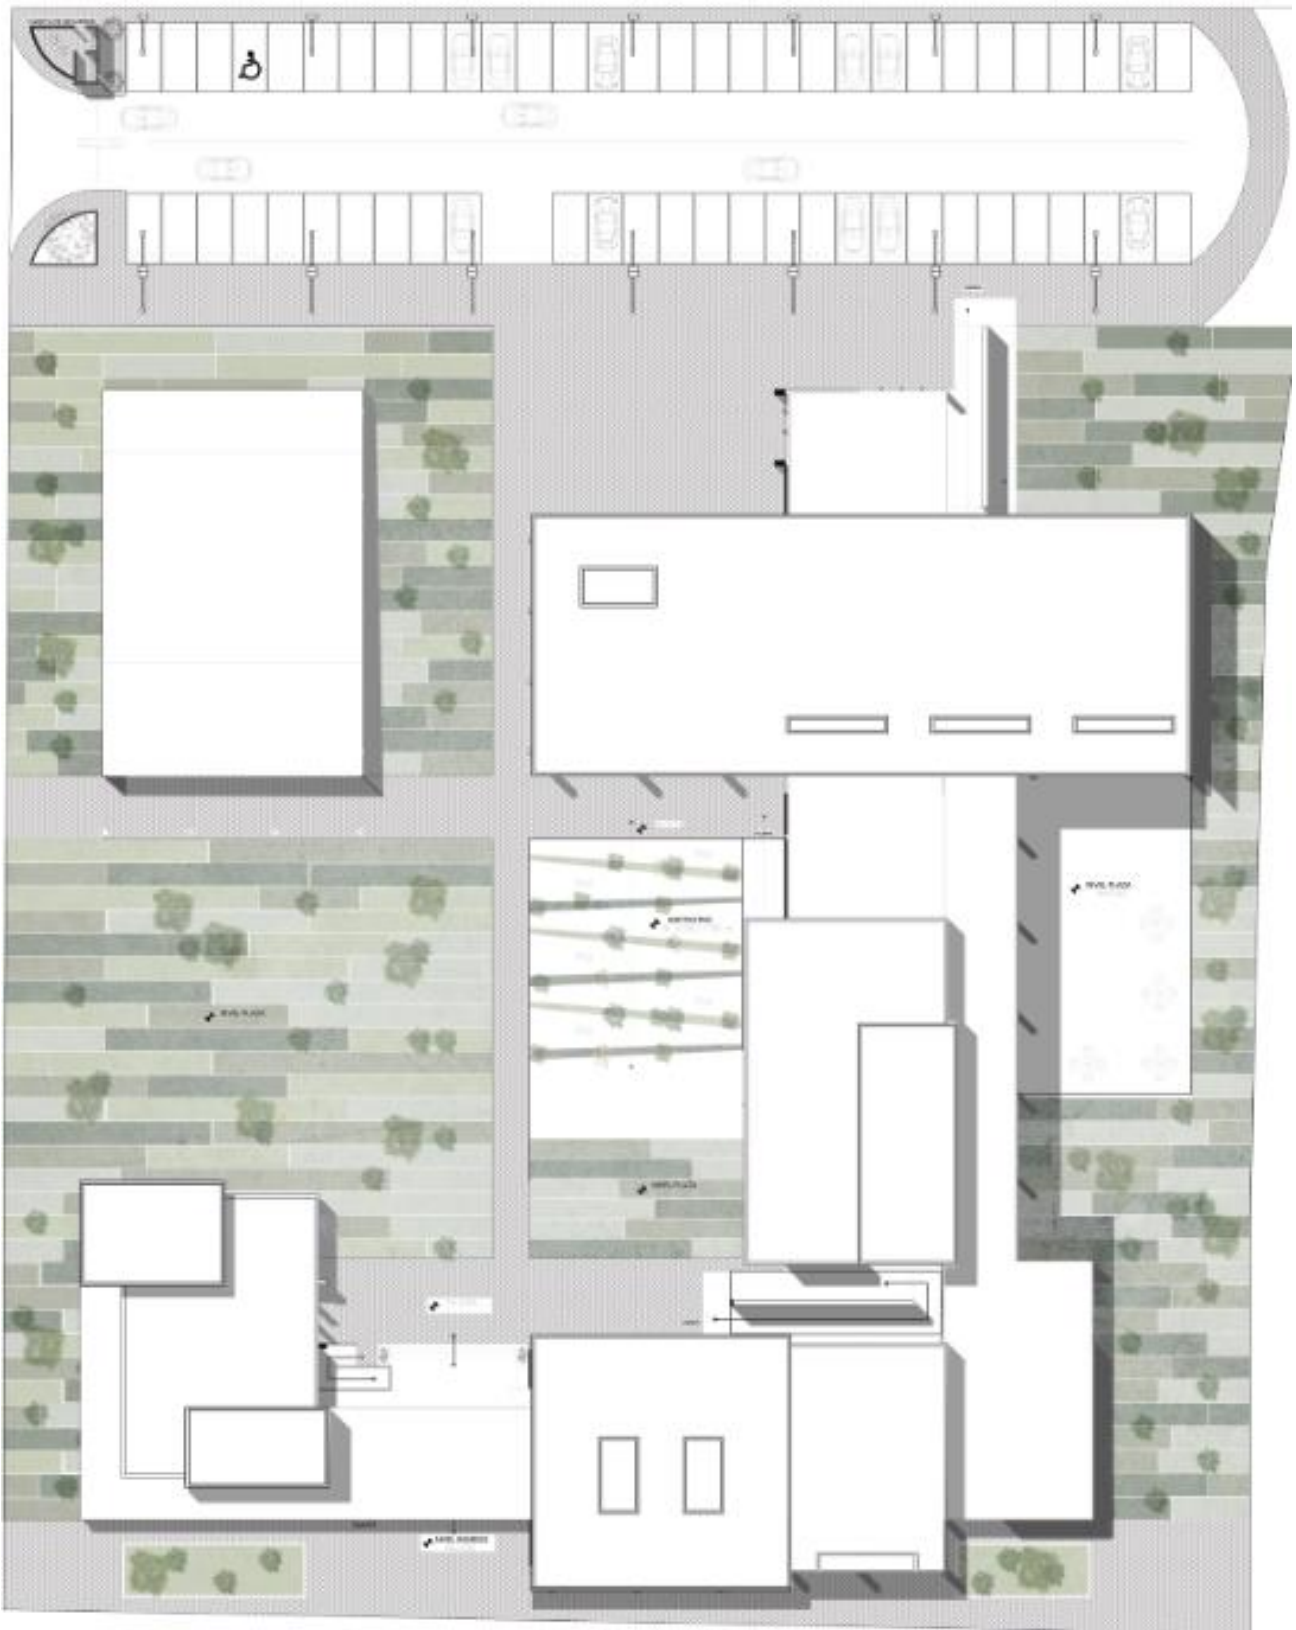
Implantación. Planta Arquitectónica. Diagrama del autor
